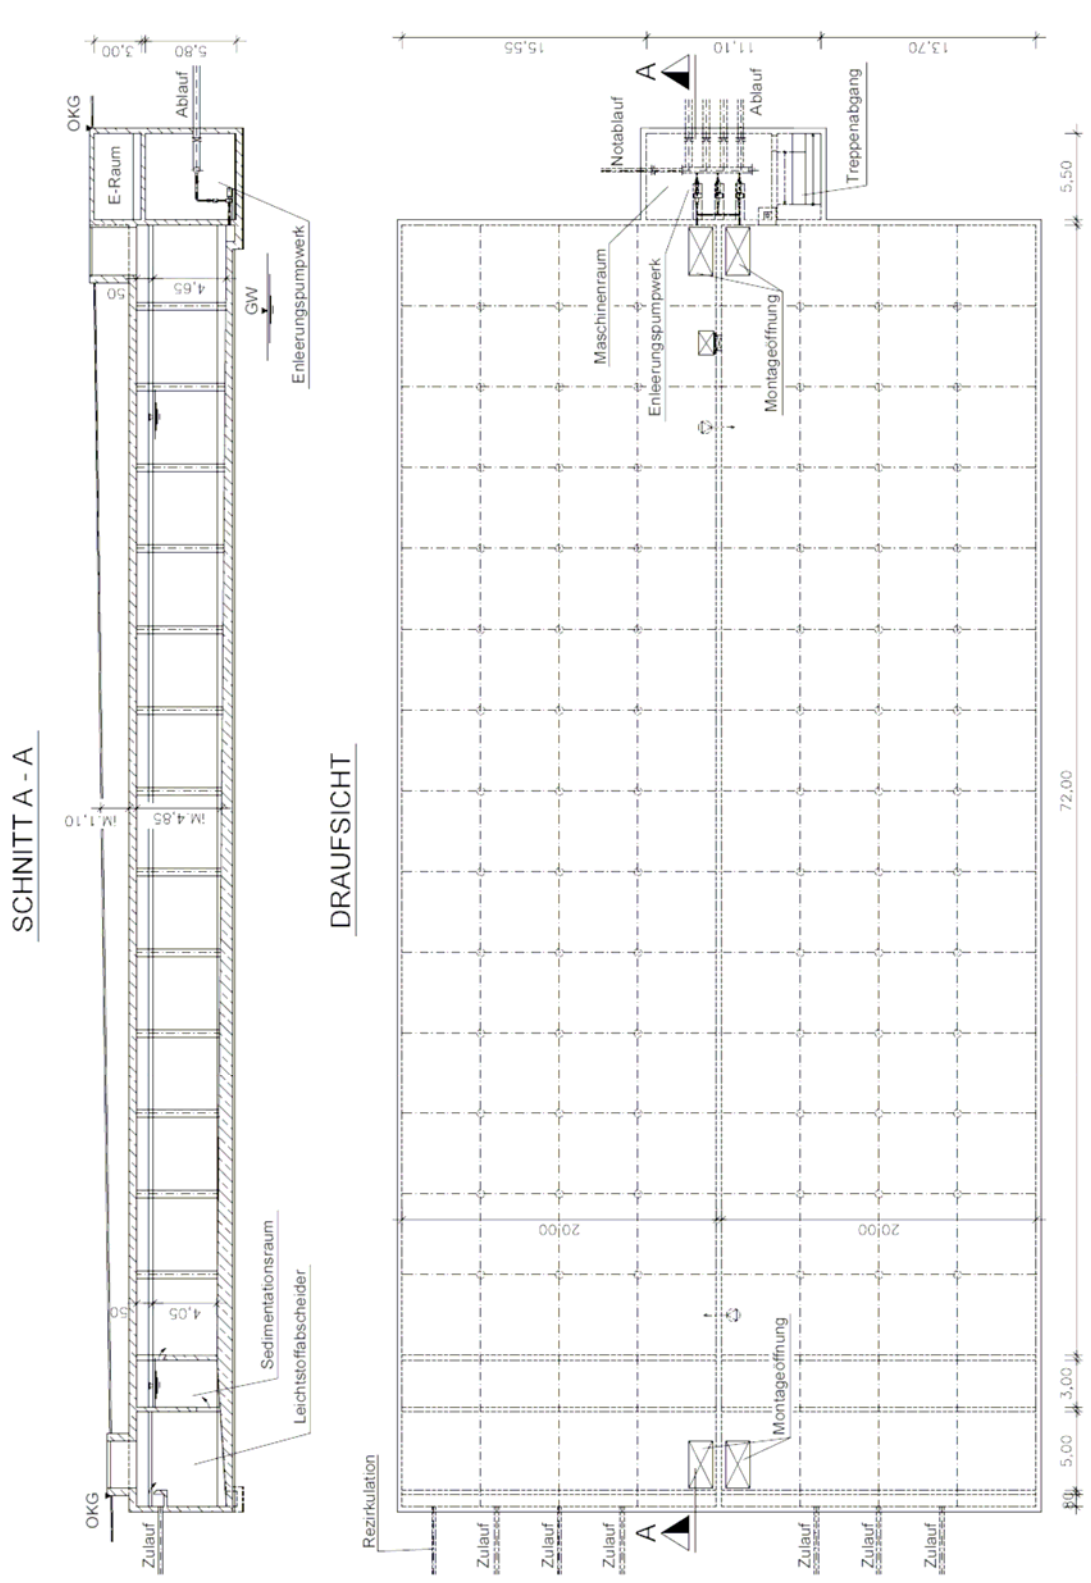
Grundriss und Schnitt Speicherbecken
